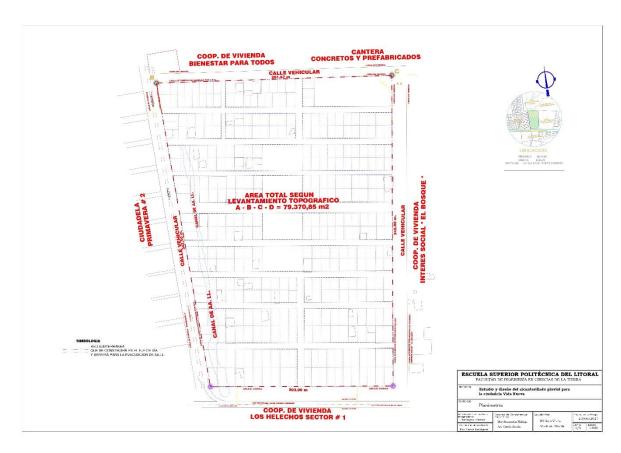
Planimetría 1. Fuente: Elaboración propia
